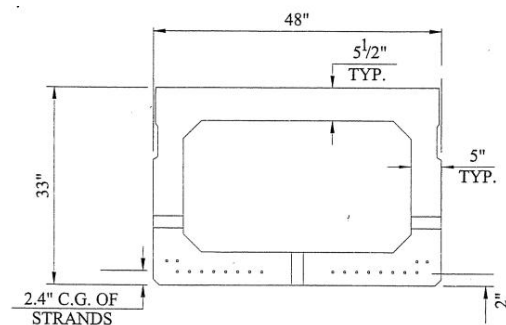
1—Sección transversal de viga tipo caja
